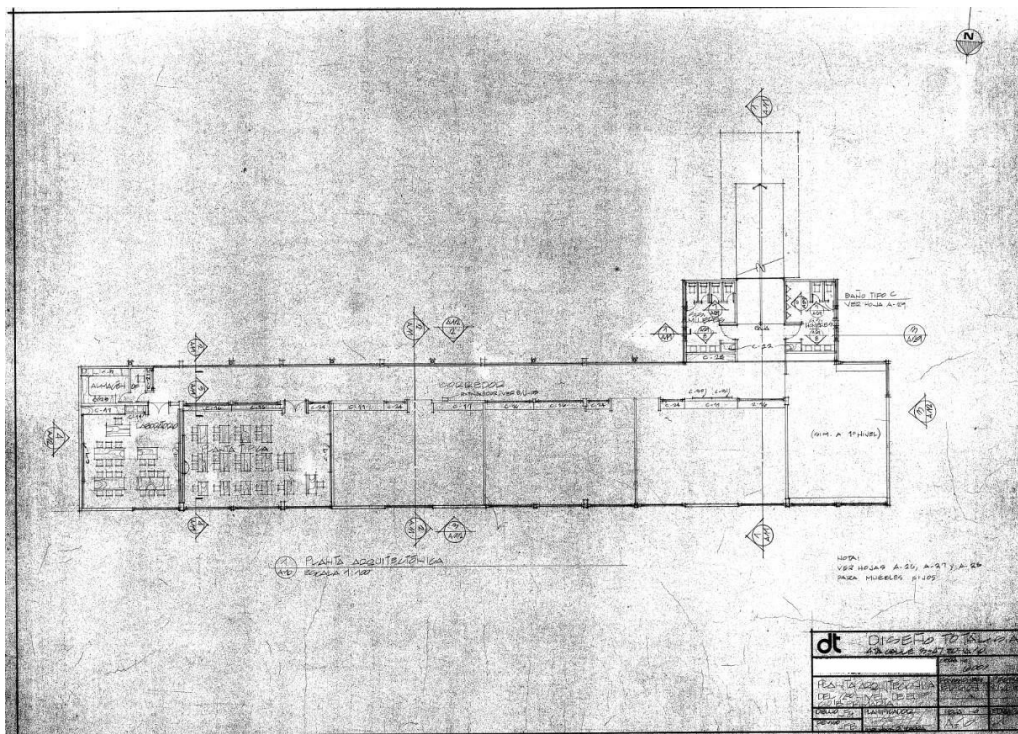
Planta arquitectónica Nivel 2 Edificio B
